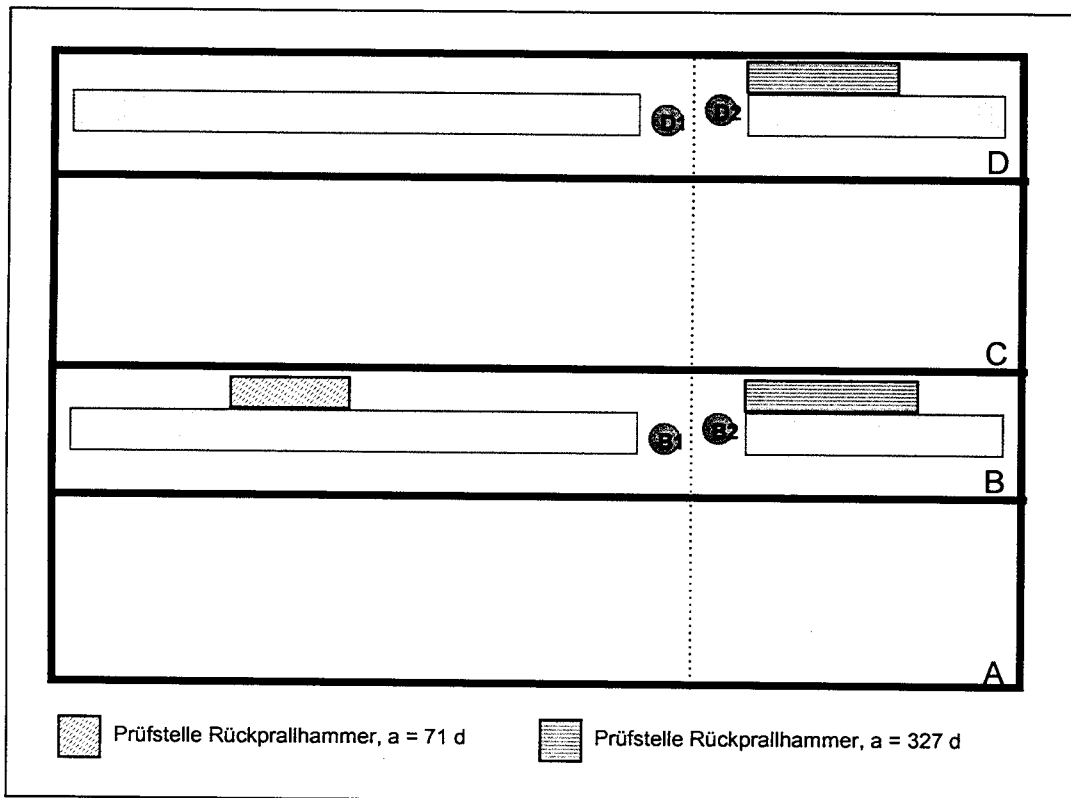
Lage der Prüfflächen am Betonkörper 18
